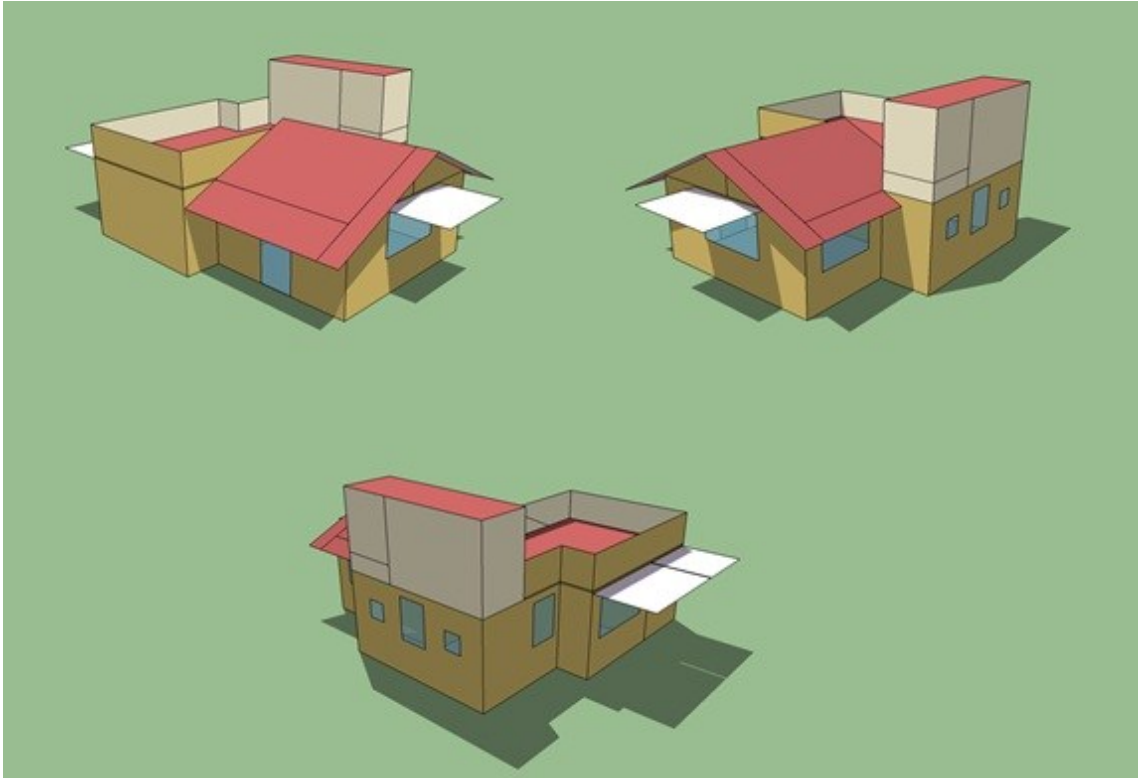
Desenho da Planta Piloto no *Google SketchUp* (Fonte: do autor).
